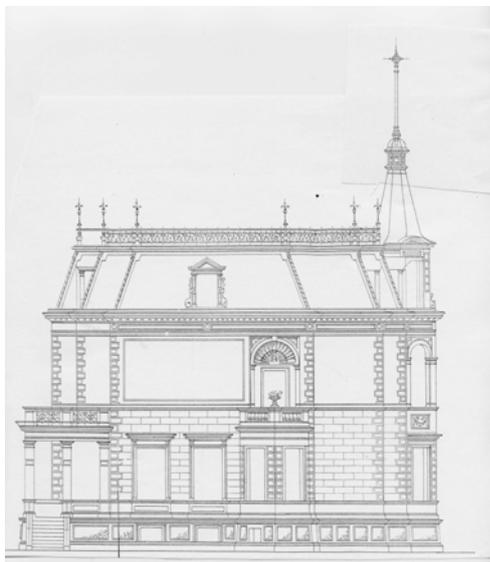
H. Plange, Aufriss Seitenfassade, 1889
